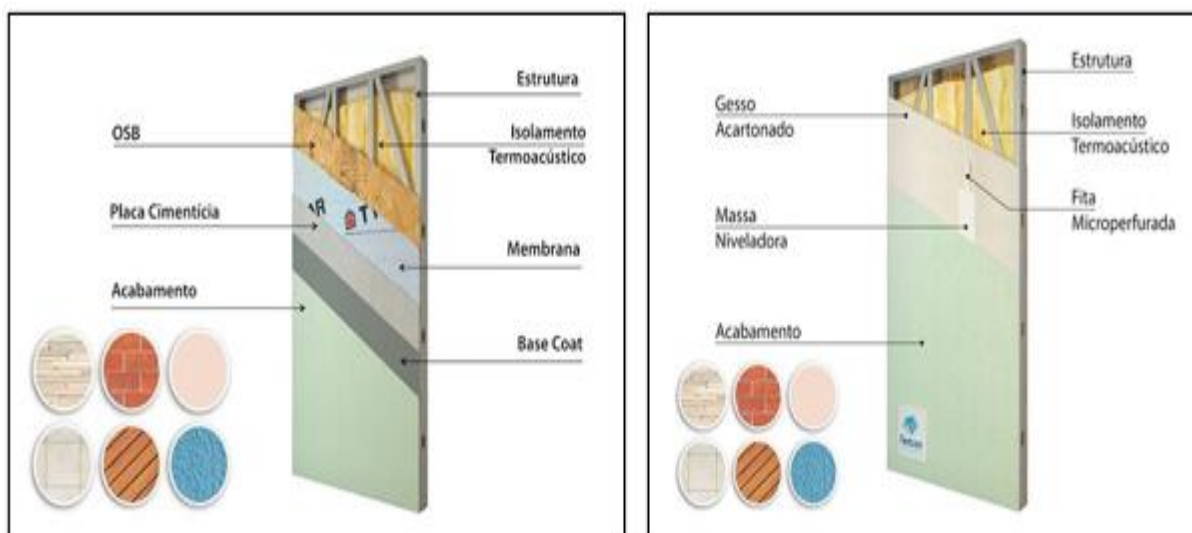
Estrutura Parede Steel Frame (Fonte: PORTAL METÁLICA)
